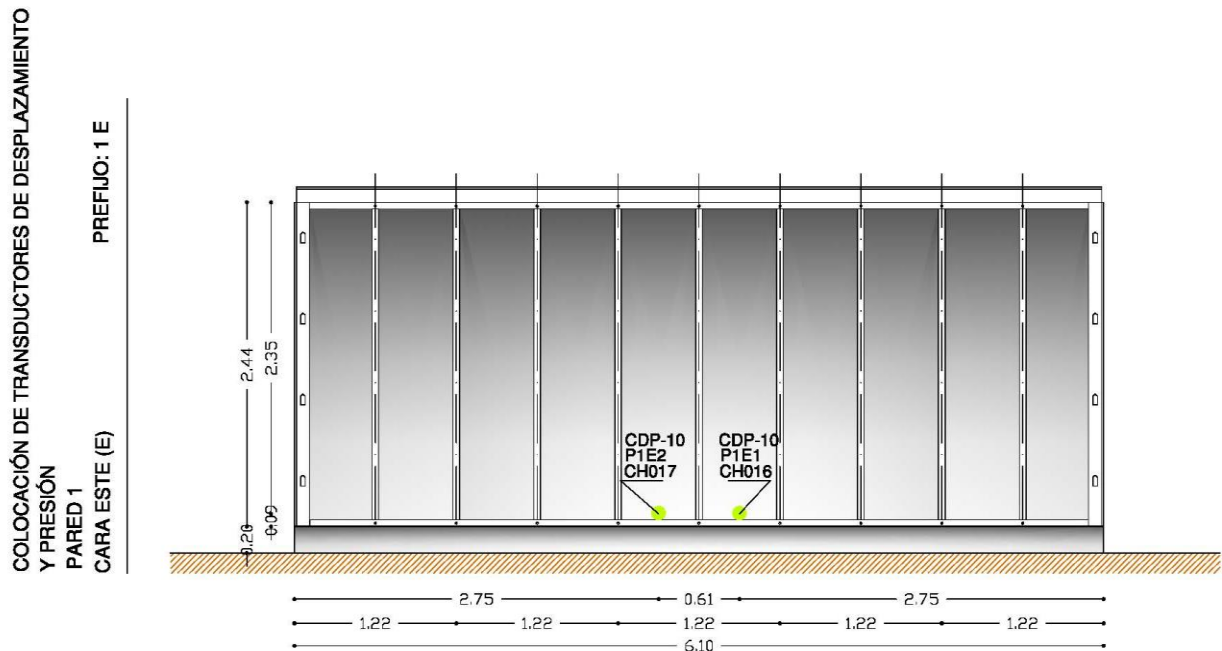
Transductores de Desplazamiento en anclajes a la cimentación.
